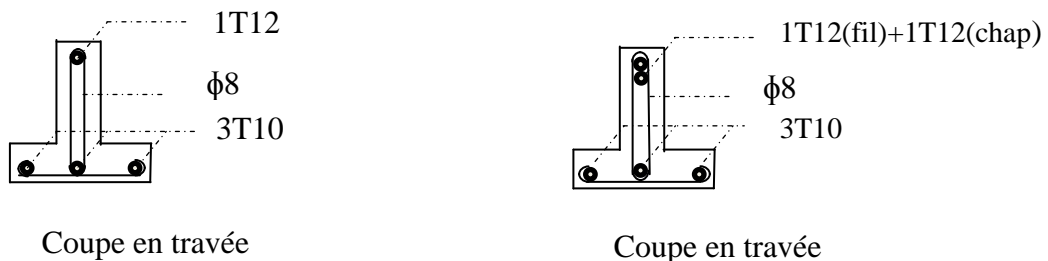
Schémas ferrailage des poutrelles Plancher Terrasse (Poutrelles intermédiaire).
